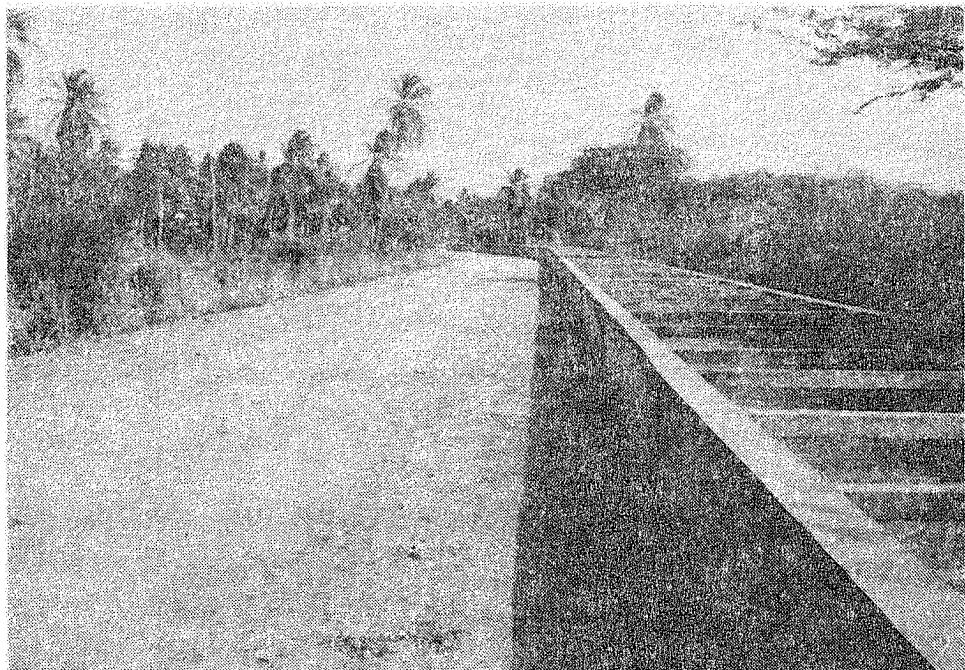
Canal principal parte rectangular, canal elevado de concreto.
